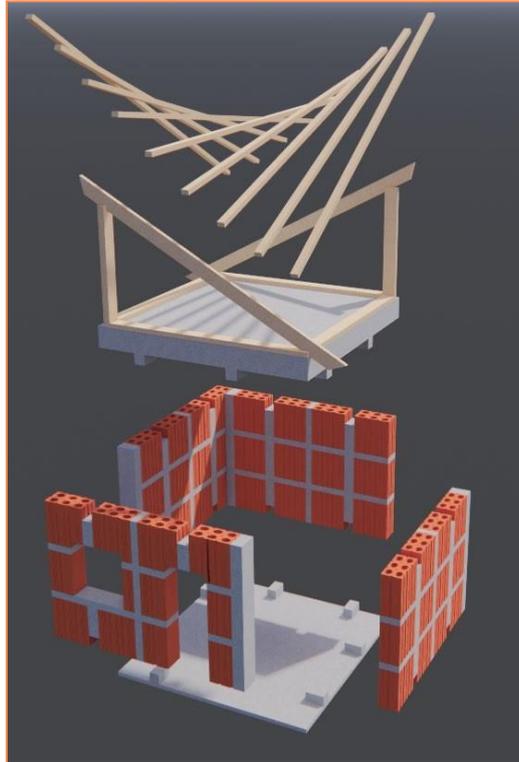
Definição de cinta de amarração para atender proposta de coberturas para a construção modular da prática em canteiro.
